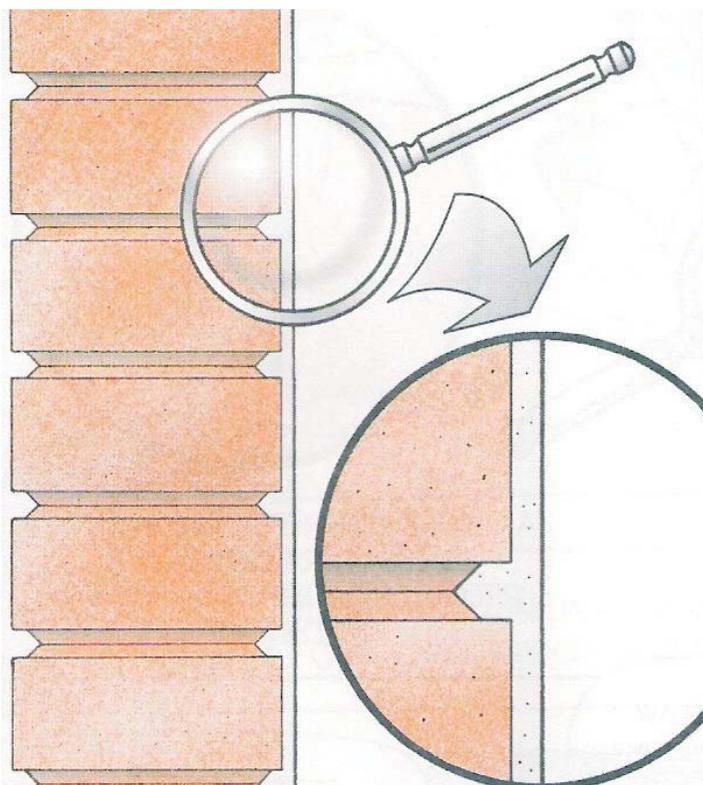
Acabamento do tijolo solo-cimento
